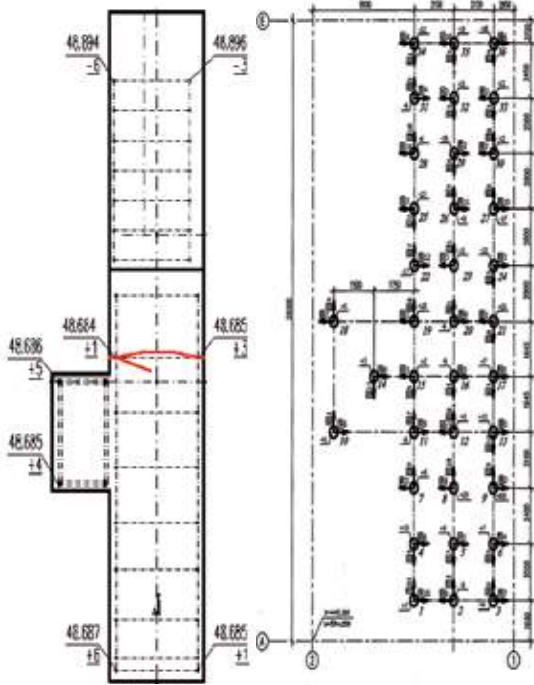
План фундамента с привязкой к абсолютным высотным отметкам, отклонениями от проектного положения, расположением трещины и планом свайного поля
